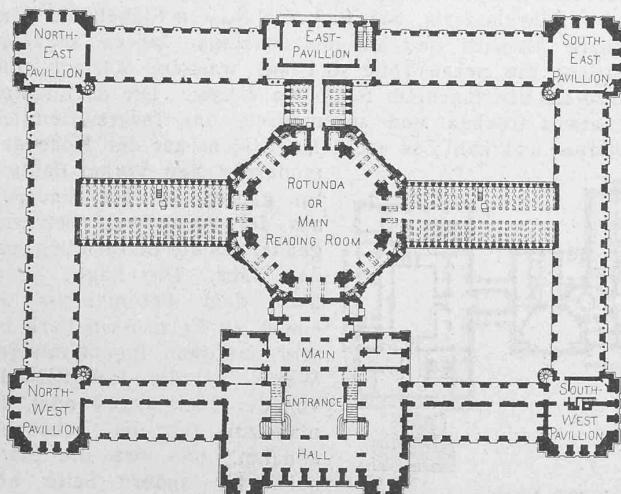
Die Kongress-Bibliothek. — Grundriss vom Hauptgeschoß.
